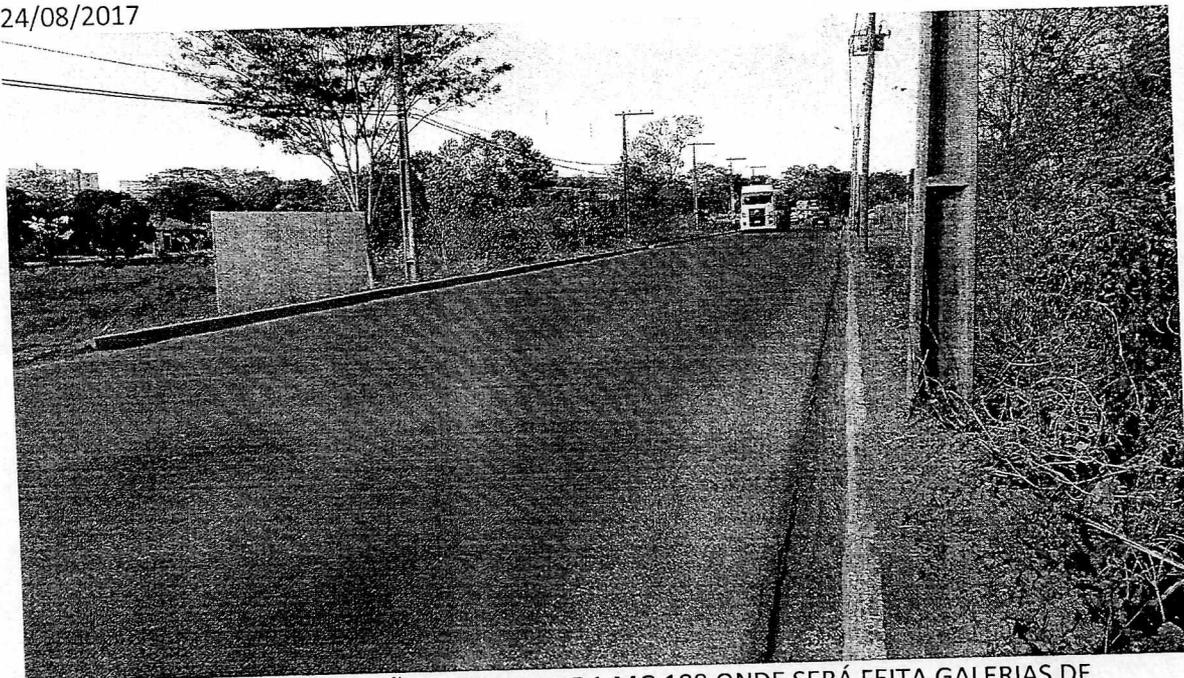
LOCAL DA DUPLICAÇÃO E CICLOVIA DA MG 188 ONDE SERÁ FEITA GALERIAS DE DRENAGEM – 24/08/2017
